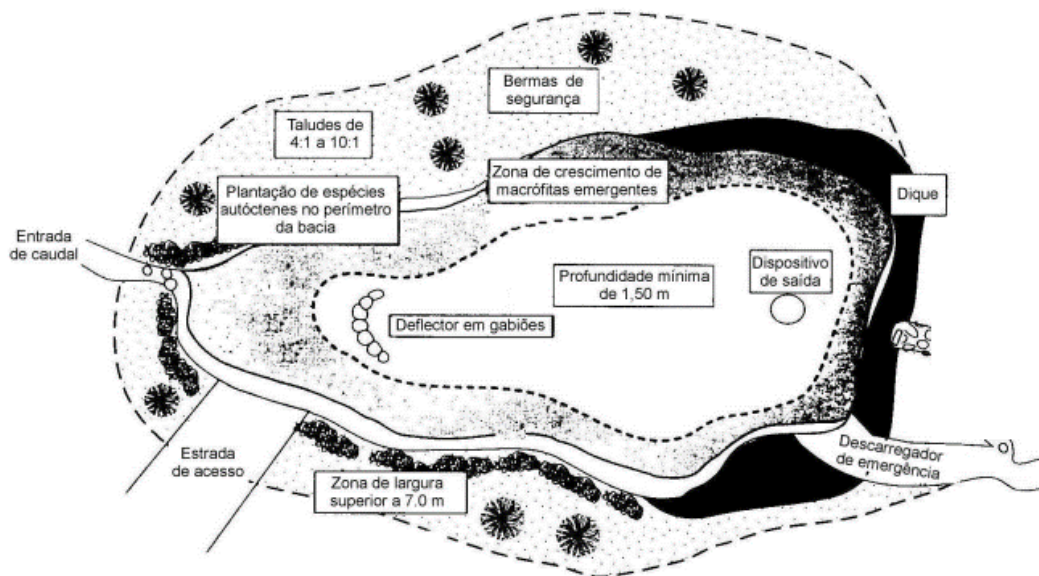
Planta tipo de uma bacia de retenção. (Retirado de: IST, 2011)
